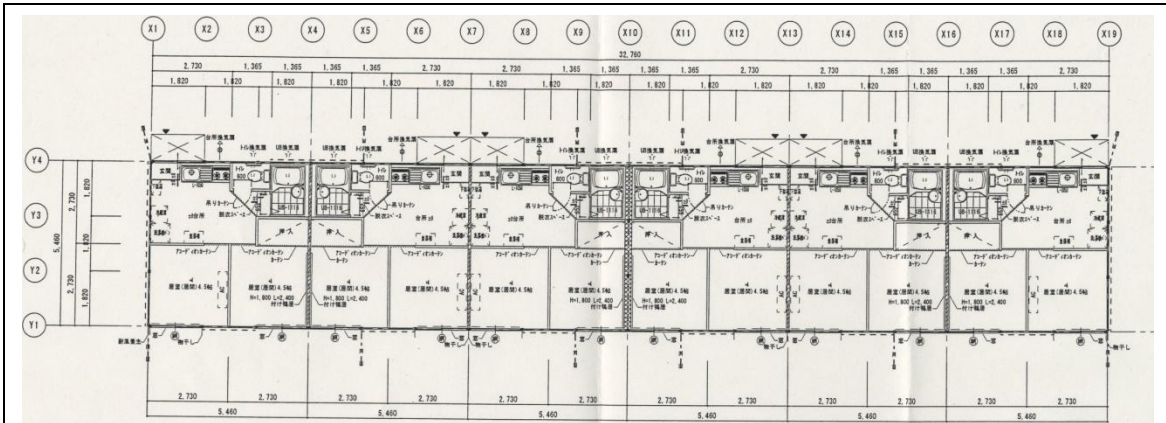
織笠仮設団地 仮設住宅平面図①
